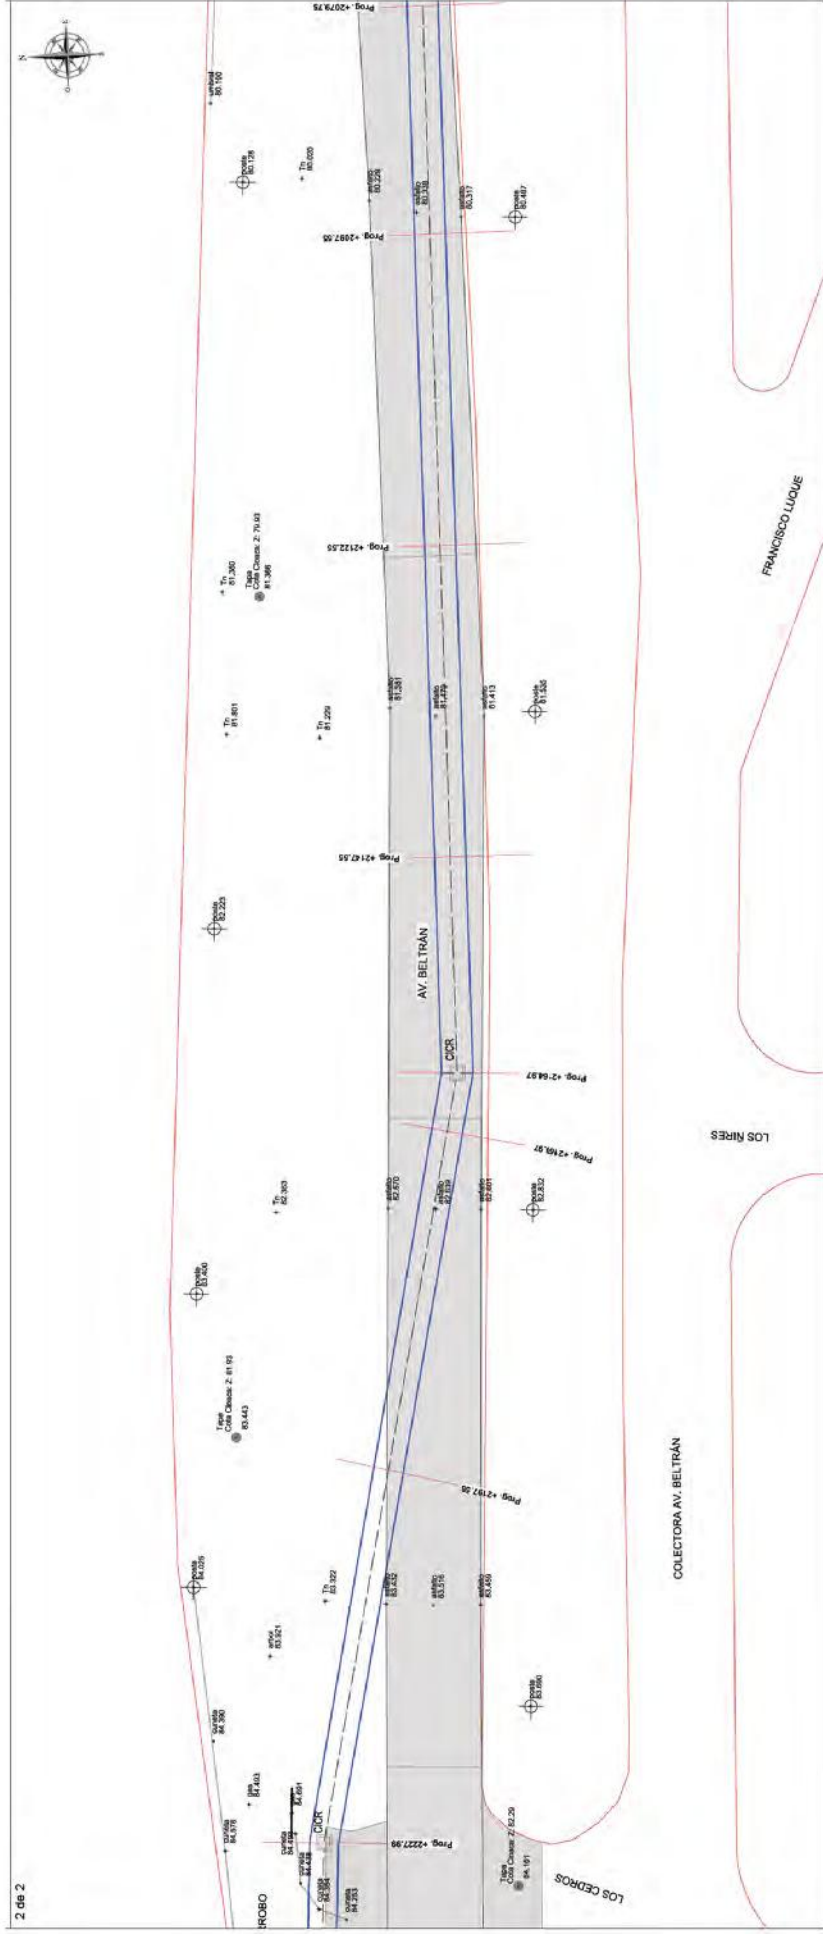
Planialtimetría de proyecto Tramo Progresiva 1926.00 m. a 2227.99 m
